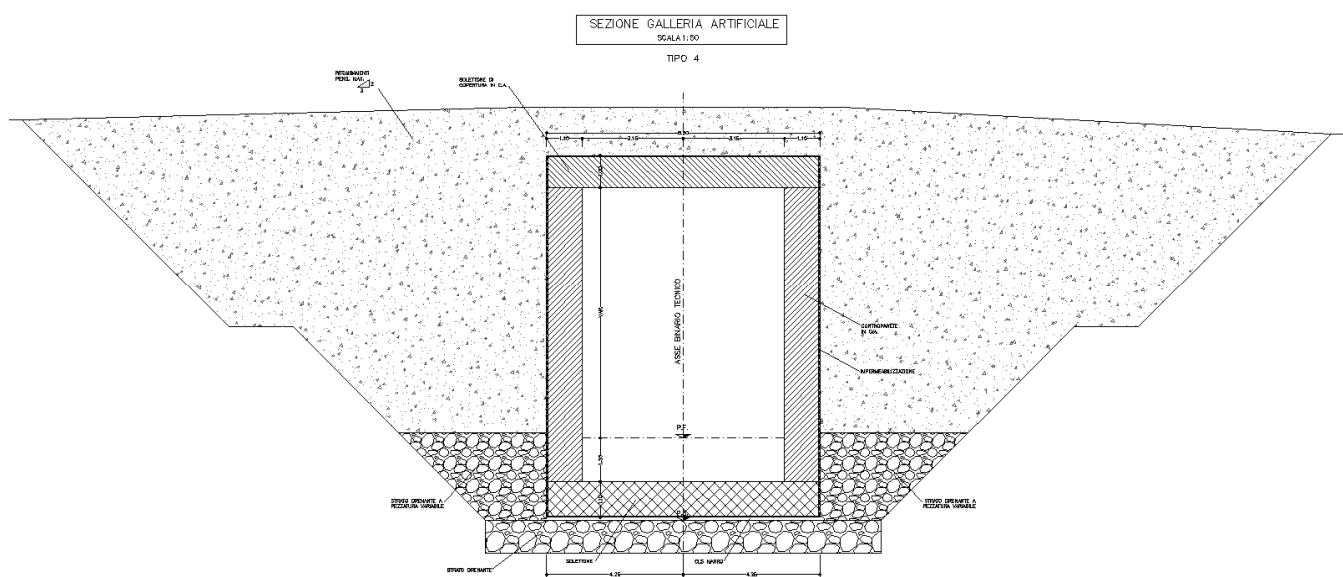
Sezione tipo Galleria artificiale "Drenante" (sezione tipo "4")
